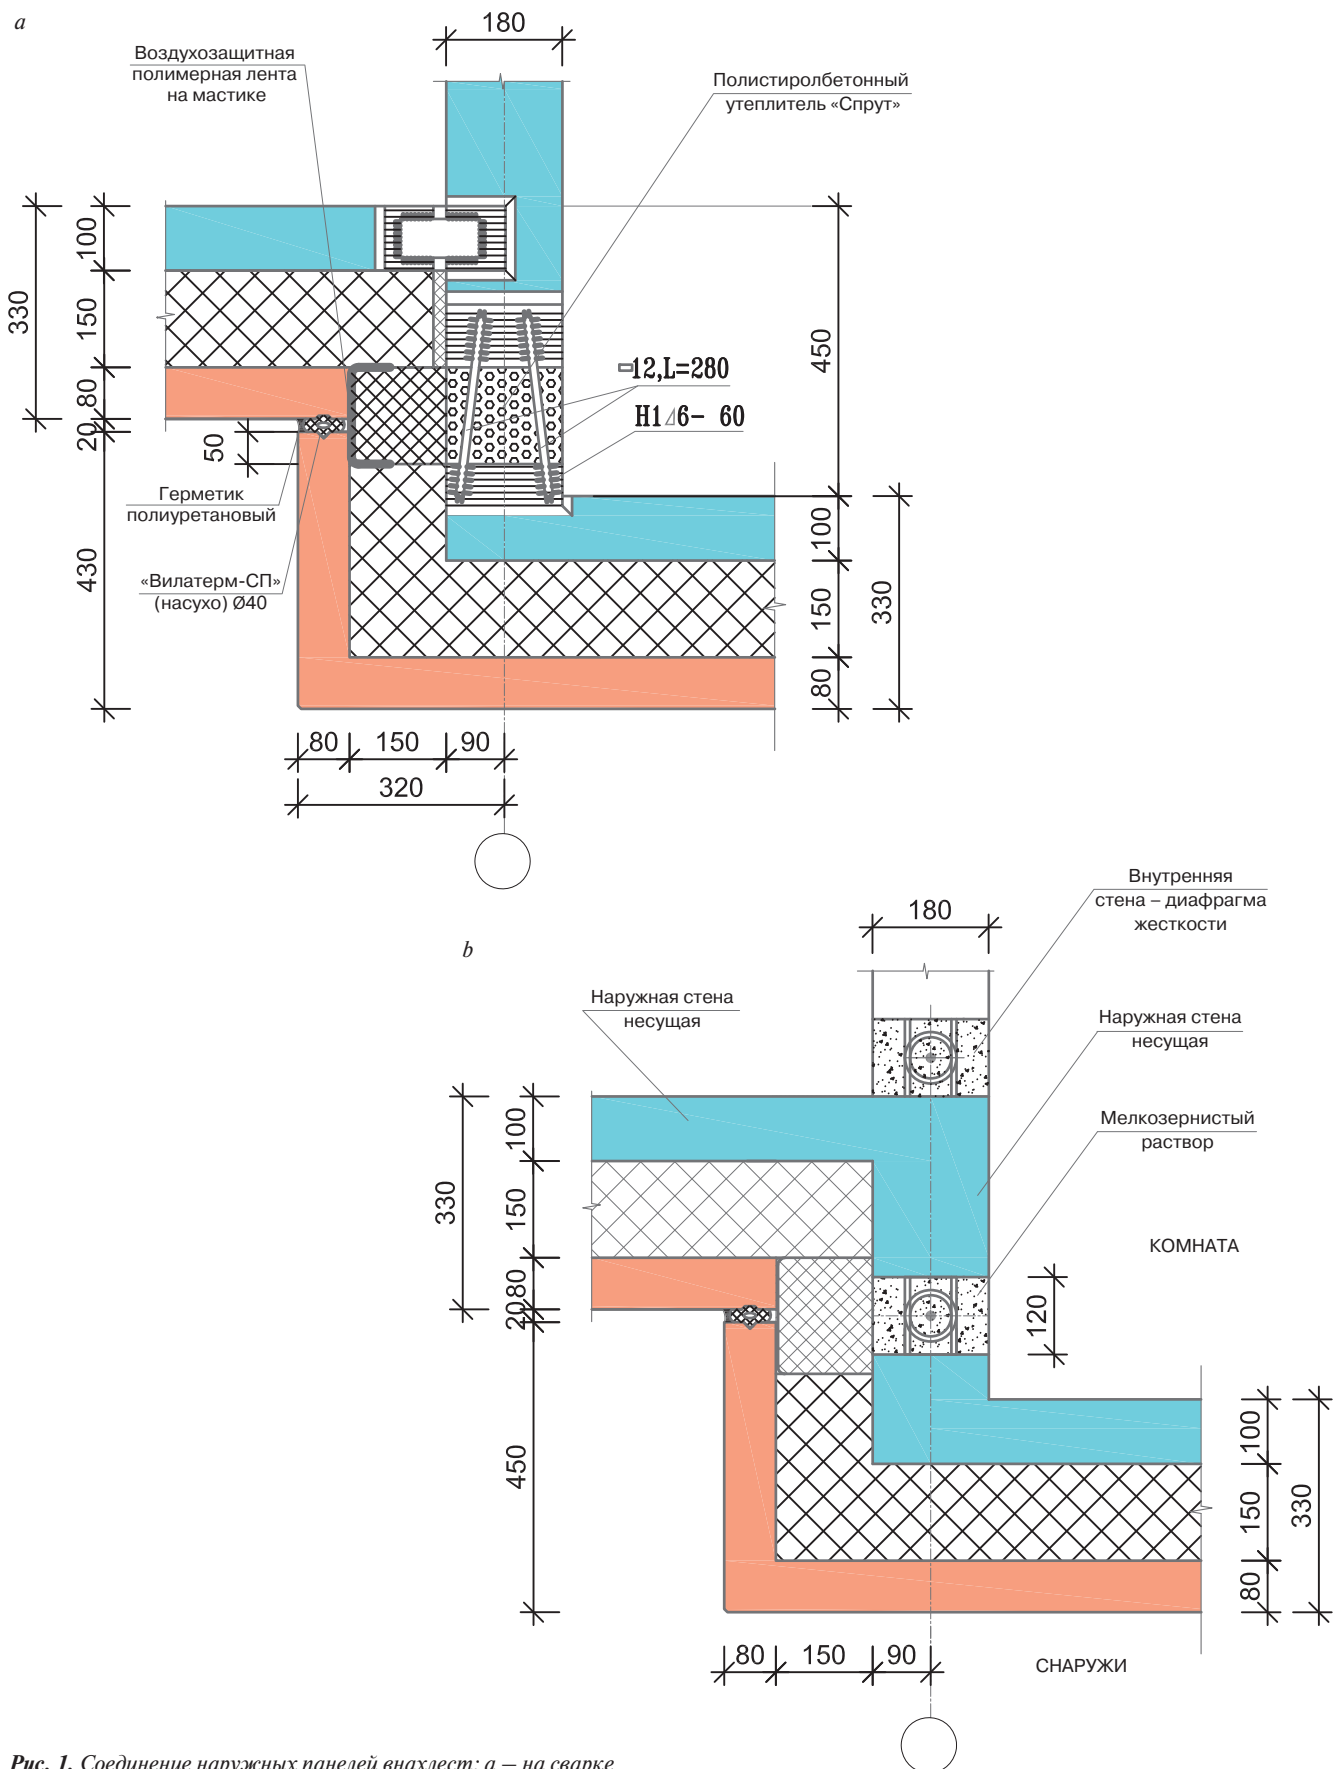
Соединение наружных панелей внахлест: а – на сварке (узкий шаг поперечных стен); б – широкий шаг стен – диафрагм жесткости
